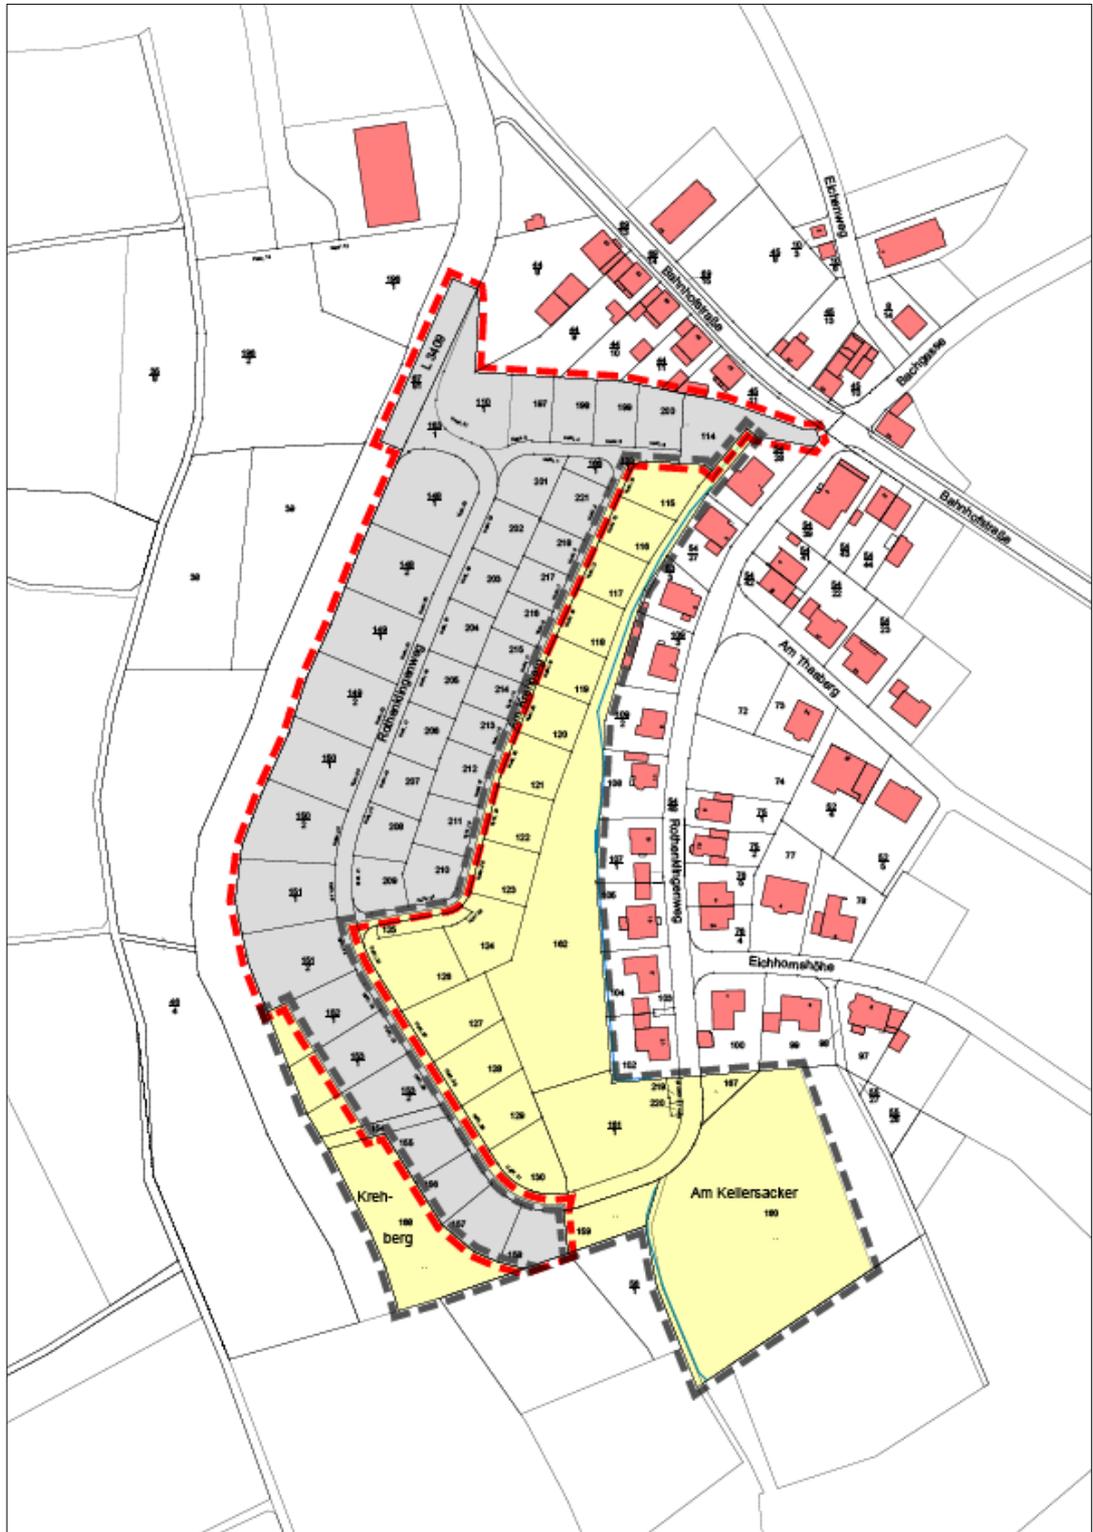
Übersichtsplan zu den Plangeltungsbereichen 1. Änderung (rote Umgrenzung, graue Fläche) und 2. Änderung (schwarze Umgrenzung, gelbe Fläche)
